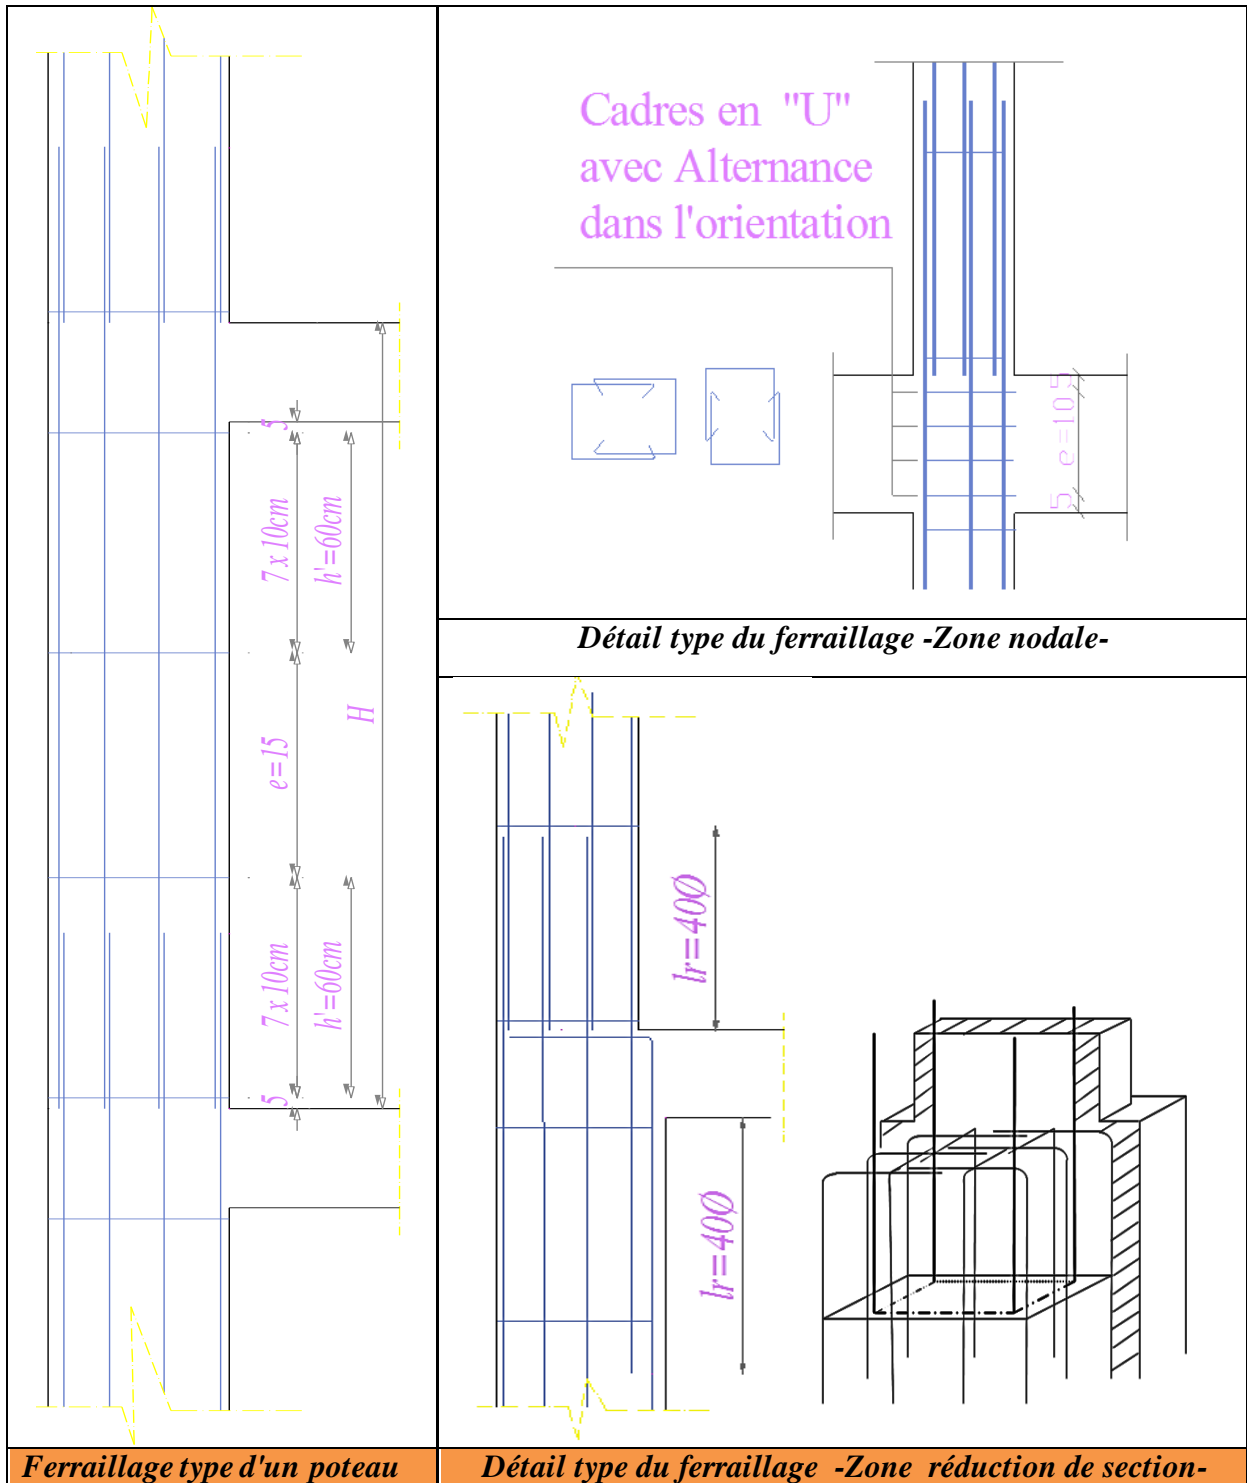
Ferrailage des poteaux (Coupe verticale)
